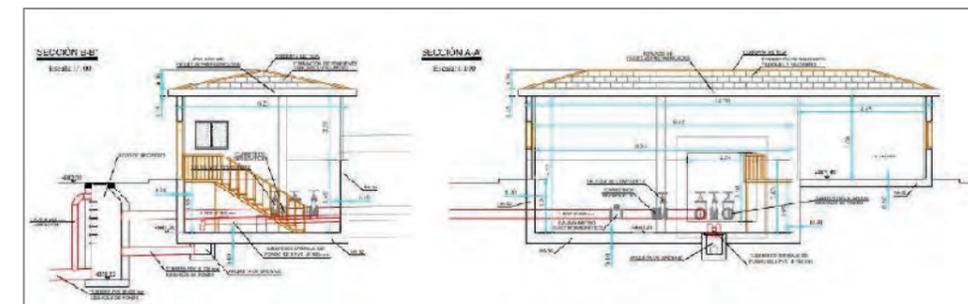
Planta de la cámara de válvulas y almacén de la Balsa de El Paso
